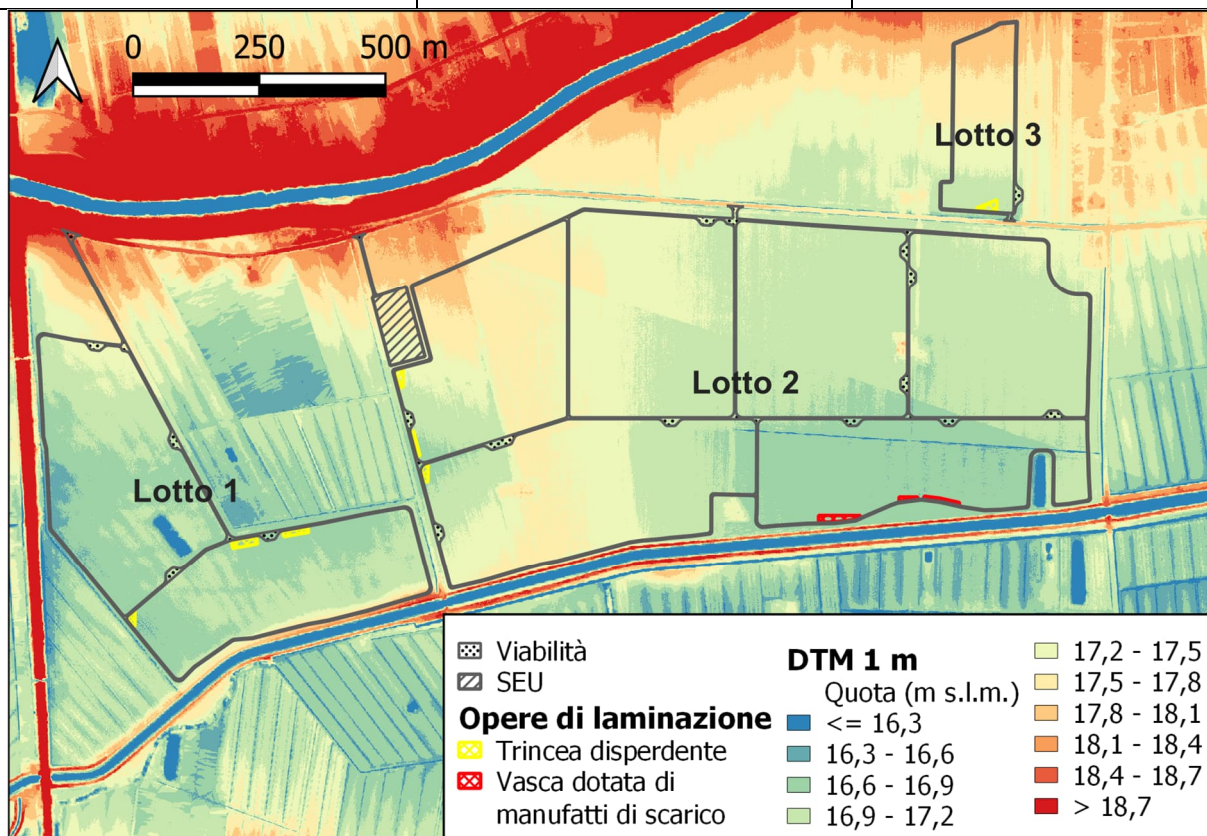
Posizionamento planimetrico delle opere di laminazione.
